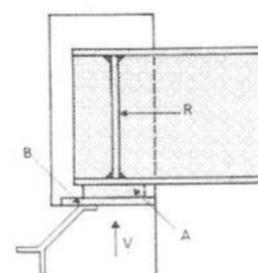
Appui simple de poutre sur un mur ou un voile en béton armé.
